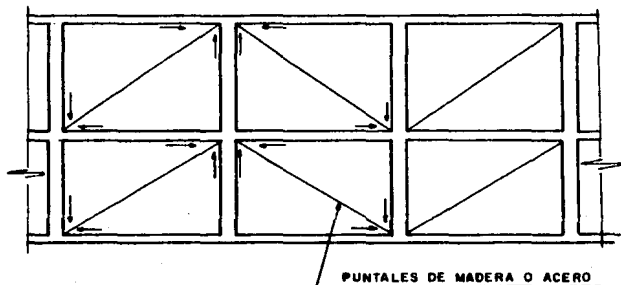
Contraventeo con puntales trabajando a compresión.
